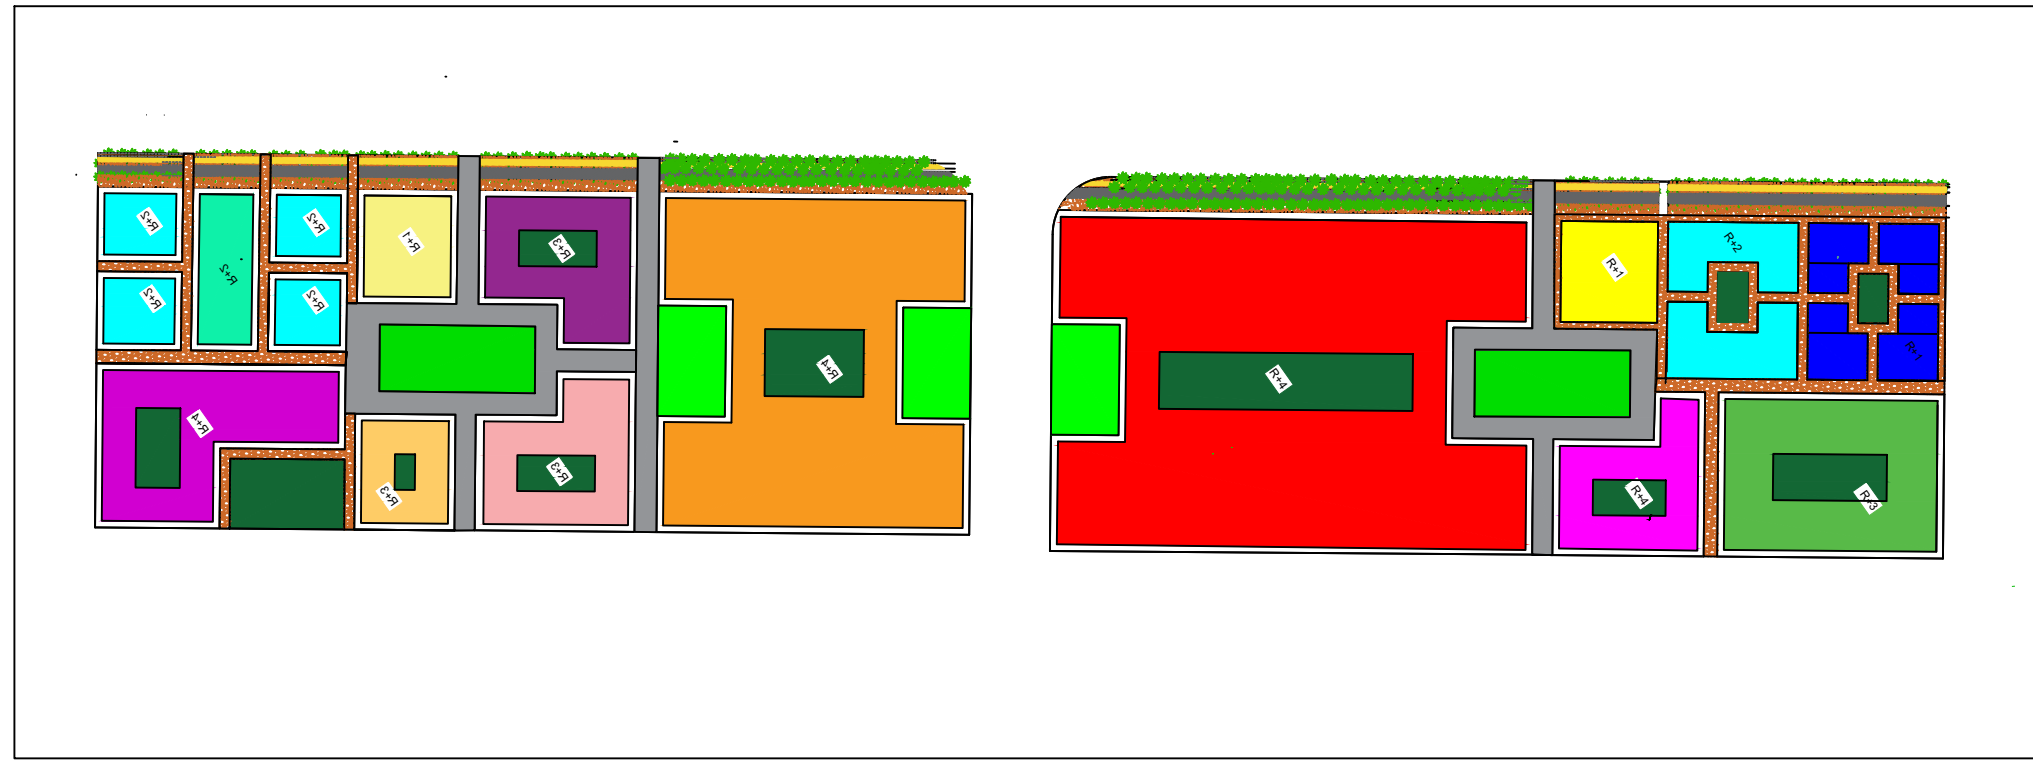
Plan d'aménagement des 2 ilots porte de la ville
